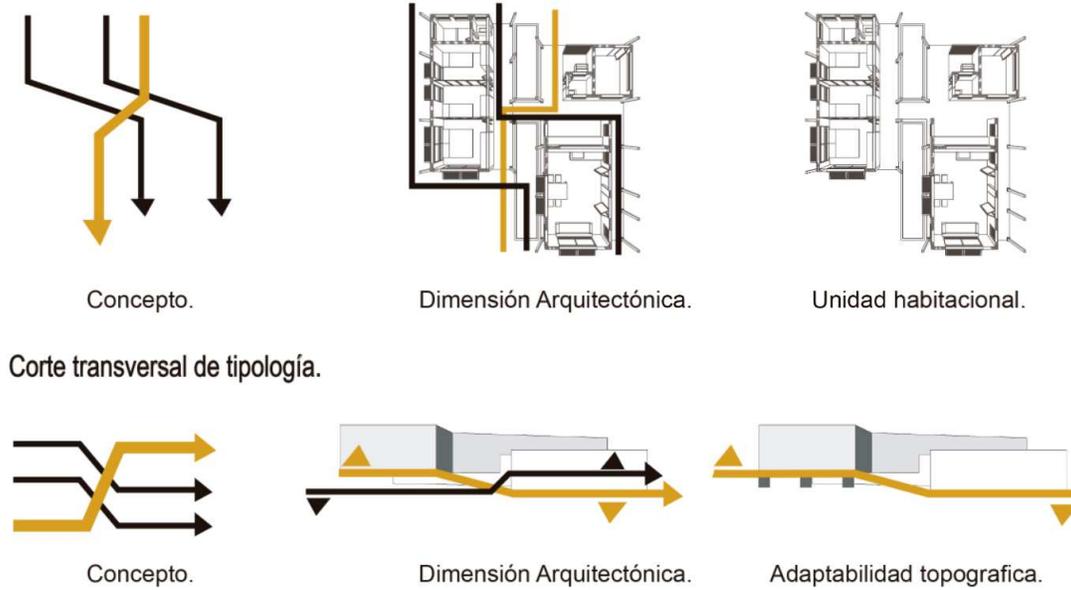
Desarrollo conceptual en la vivienda, planta y corte, fuente propia.
